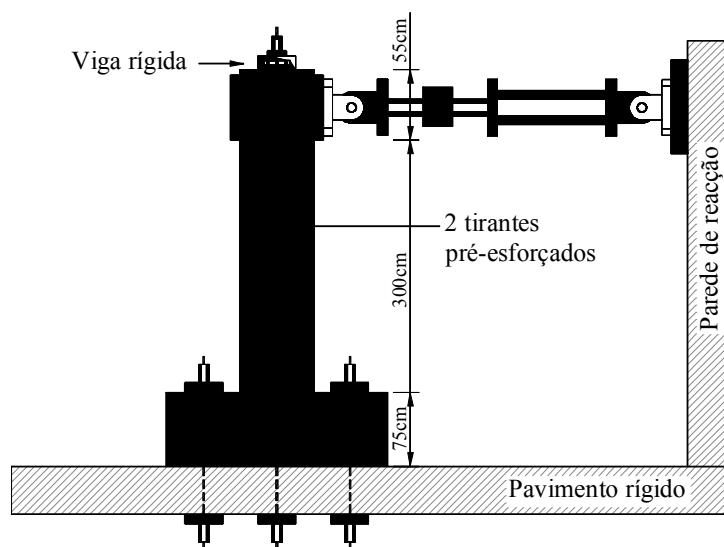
(a) - Setup de ensaio de pilares de betão armado de ponte (Chang et al., 2004).
